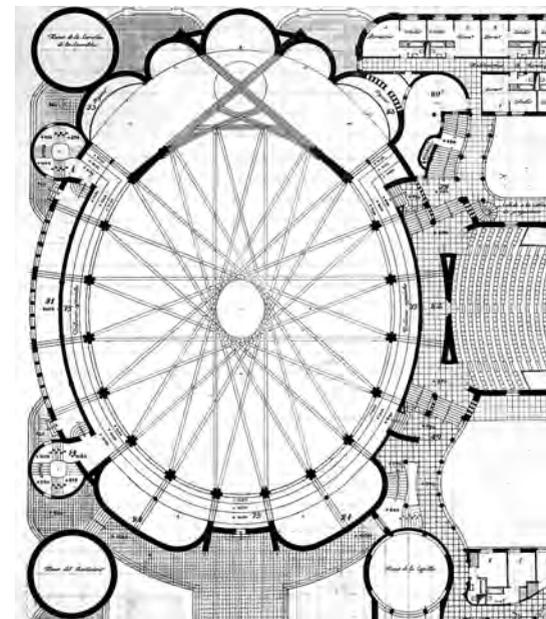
Planta de la cúpula -no construida- para la catedral metropolitana de San Salvador (1953), con trazado en estrella de veinte puntas: similar a las grandes iglesias de Moya en España, pero con arcos y estructura de hormigón
